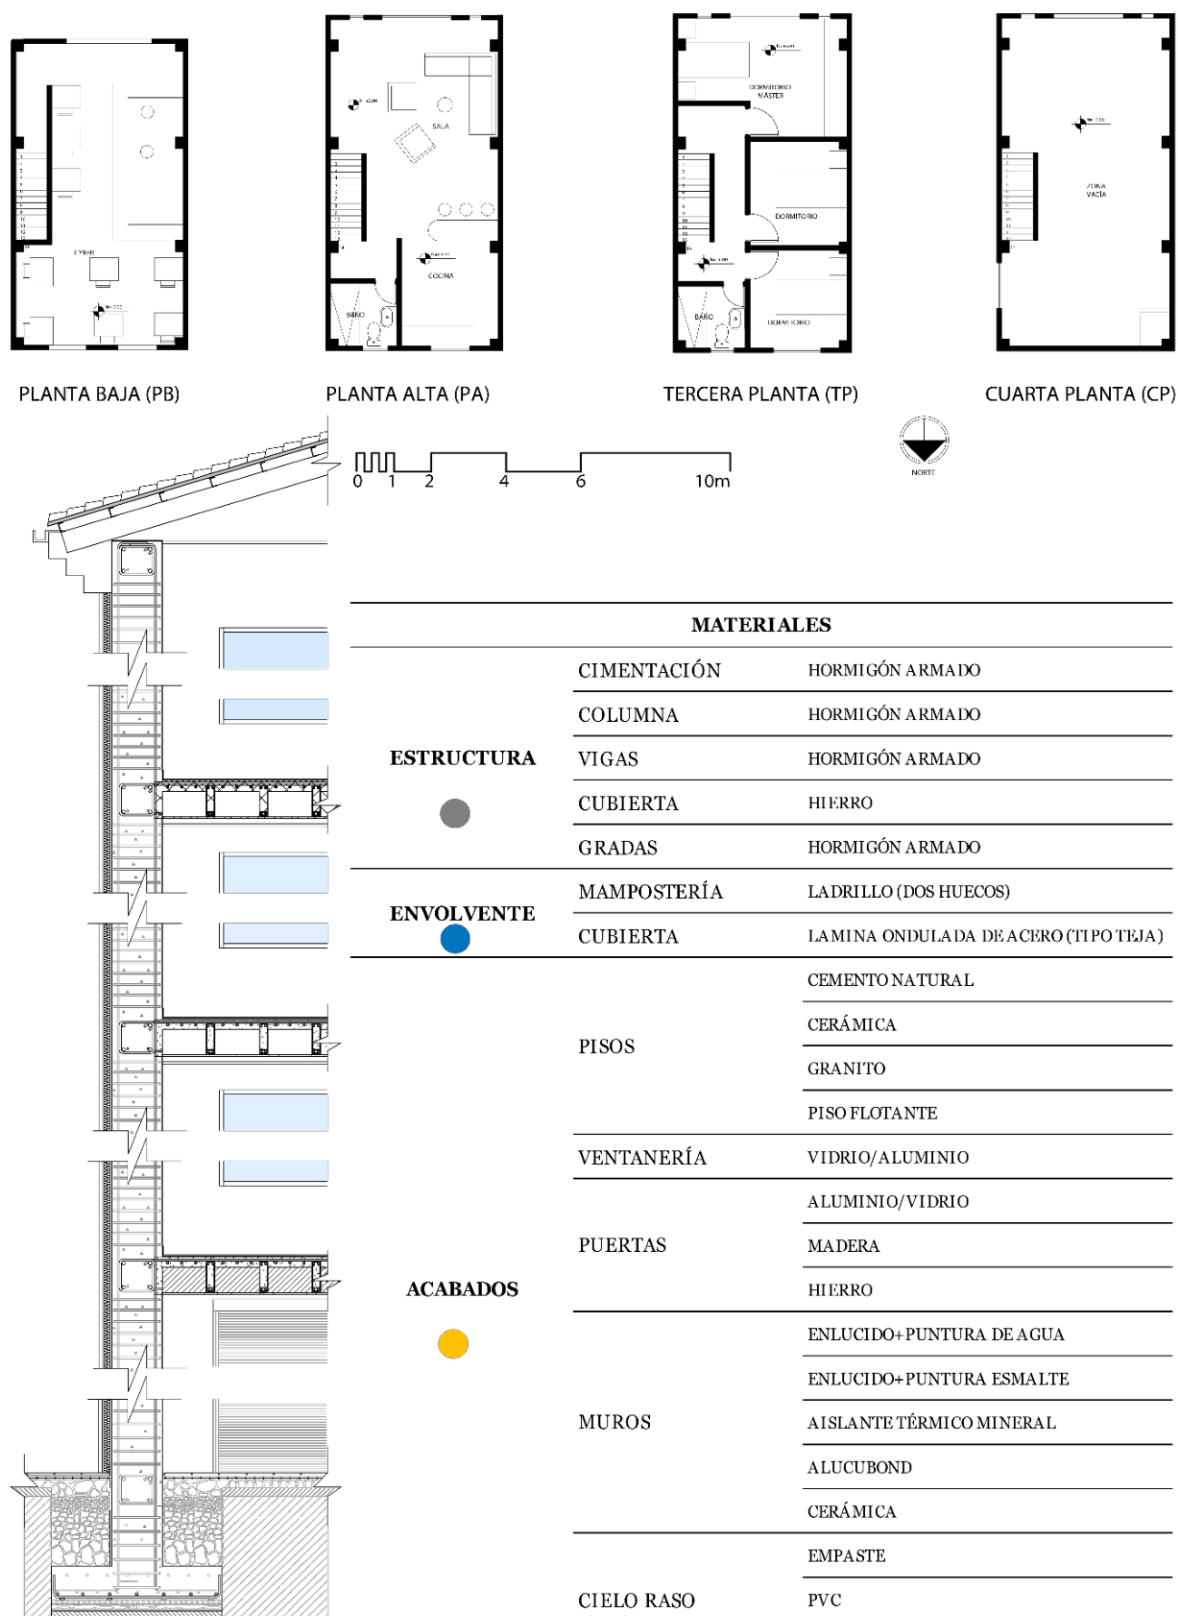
a) Planos arquitectónicos de la Casa Poma b) Sección constructiva. Fuente: Elaboración propia.
